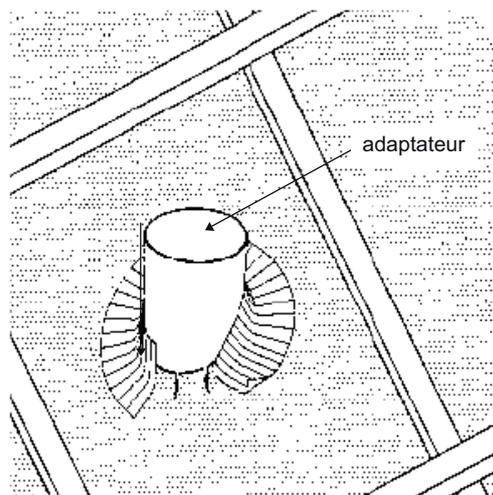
Sortie de conduit de ventilation (raccord avec dispositif déflecteur)
